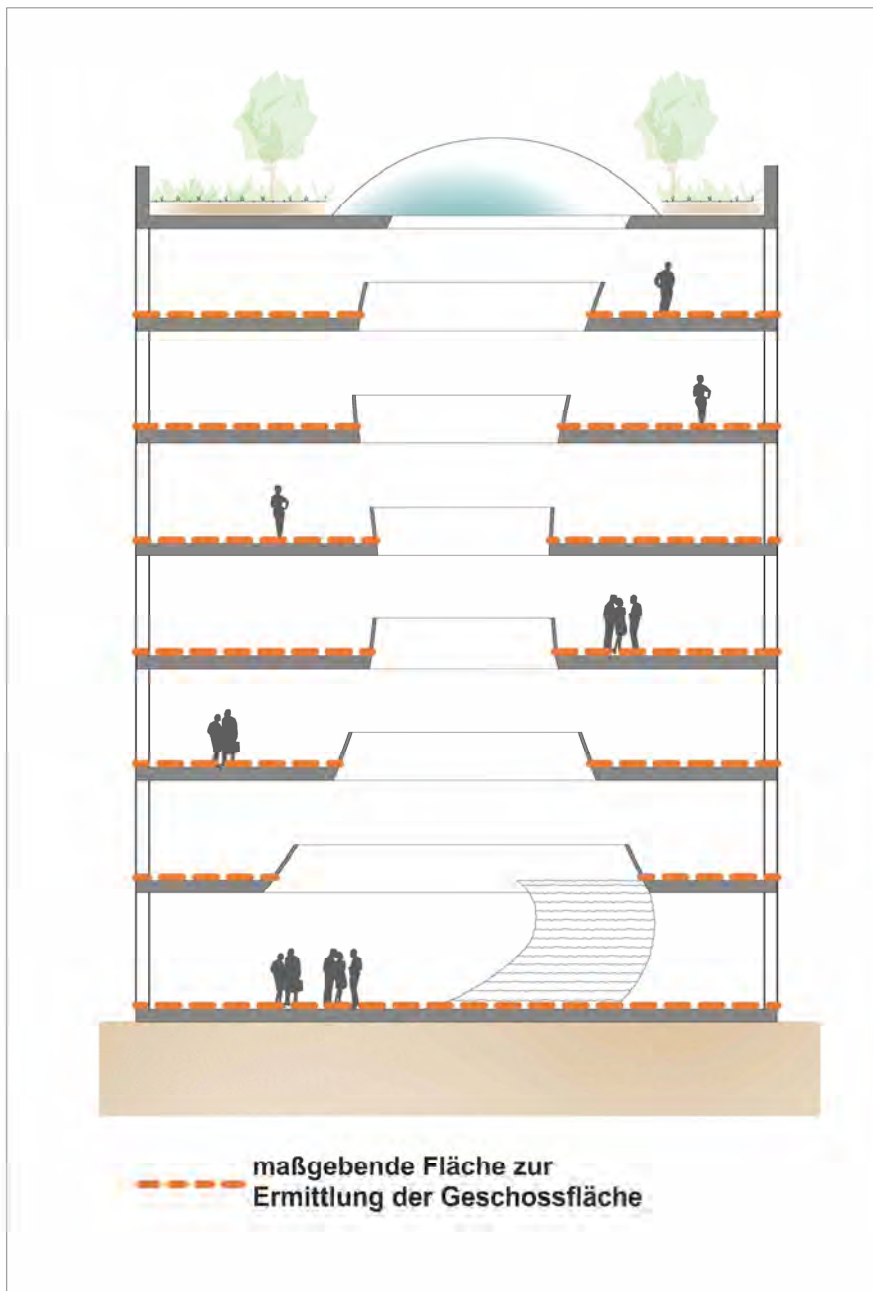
Schemaschnitt zur Ermittlung der maßgebenden Fläche der Geschossfläche (Quelle: Planquadrat, Darmstadt)
